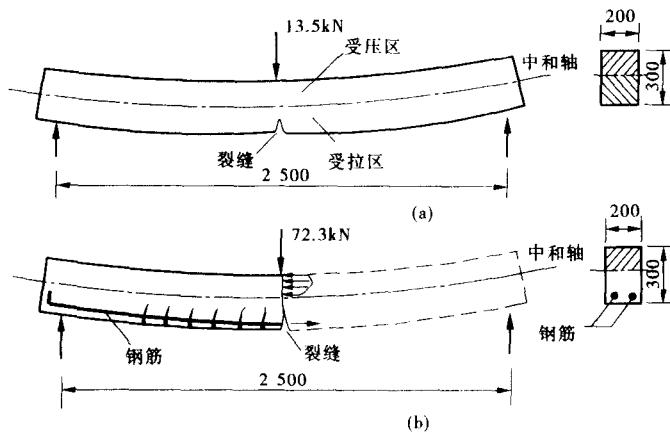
混凝土及钢筋混凝土简支梁的承载力 (单位:mm)
